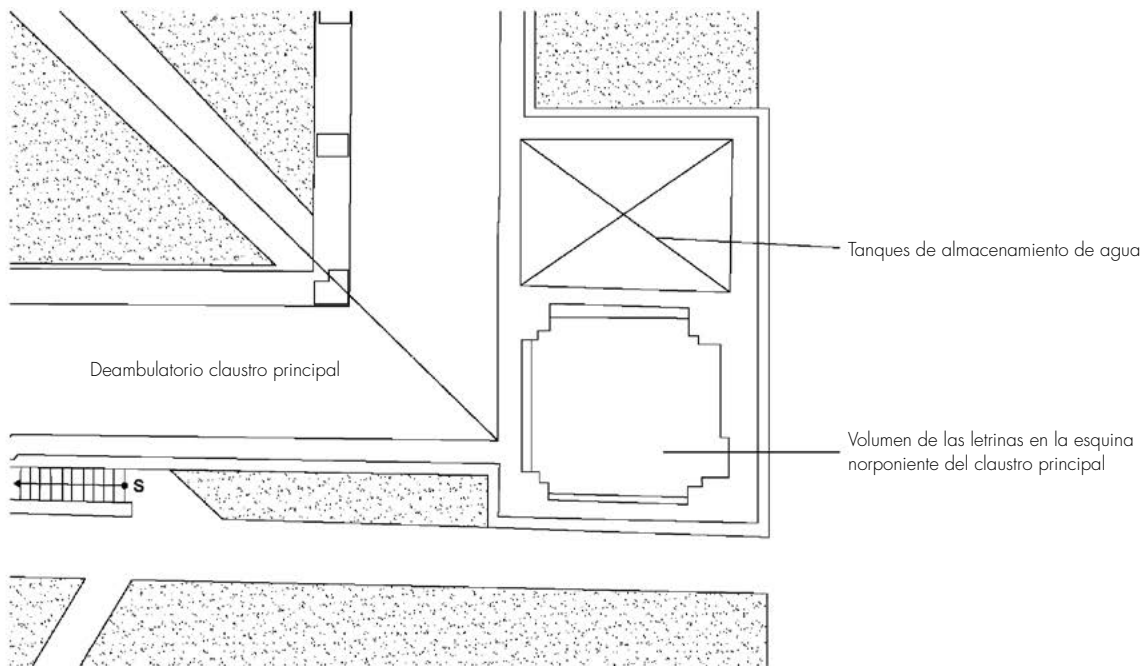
Planta de las letrinas con la ubicación en relación con el claustro principal. Plano de Restauro Compas y Canto.
